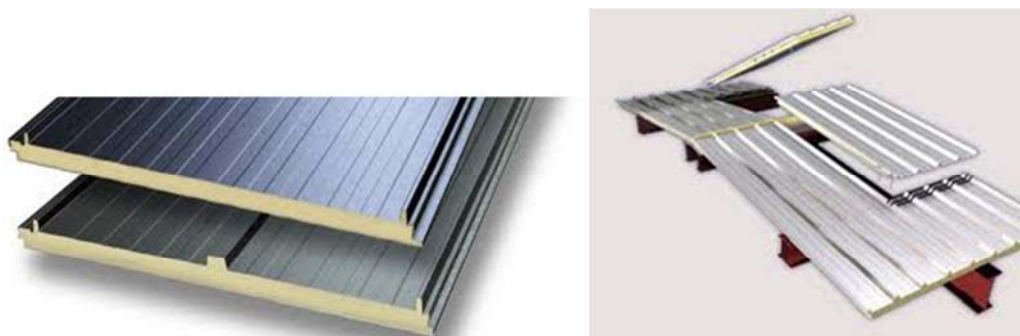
y 40 respectivamente. Detalles constructivos del aislamiento y del trasdosado a colocar en la "propuesta 1 Mejora de la envolvente"
